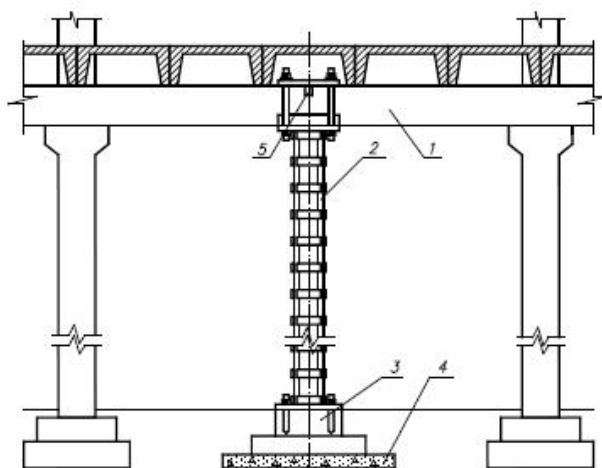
Усиление дополнительной жесткой опорой с самостоятельным фундаментом: 1- усиливаемая конструкция, 2- стойка дополнительной опоры, 3- фундамент опоры, 4- песчано-щебеночная подушка, 5-надрез.
